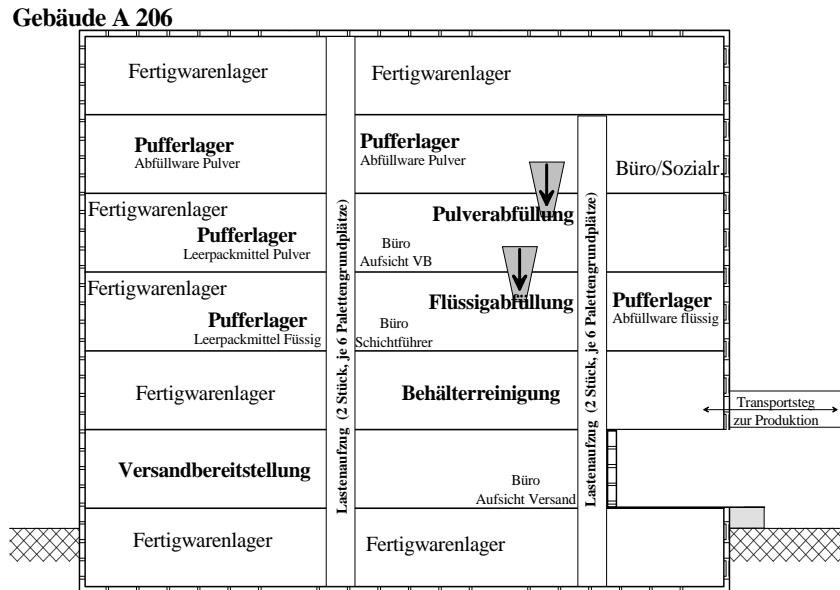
Grundriß von Gebäude A 206²¹⁹
